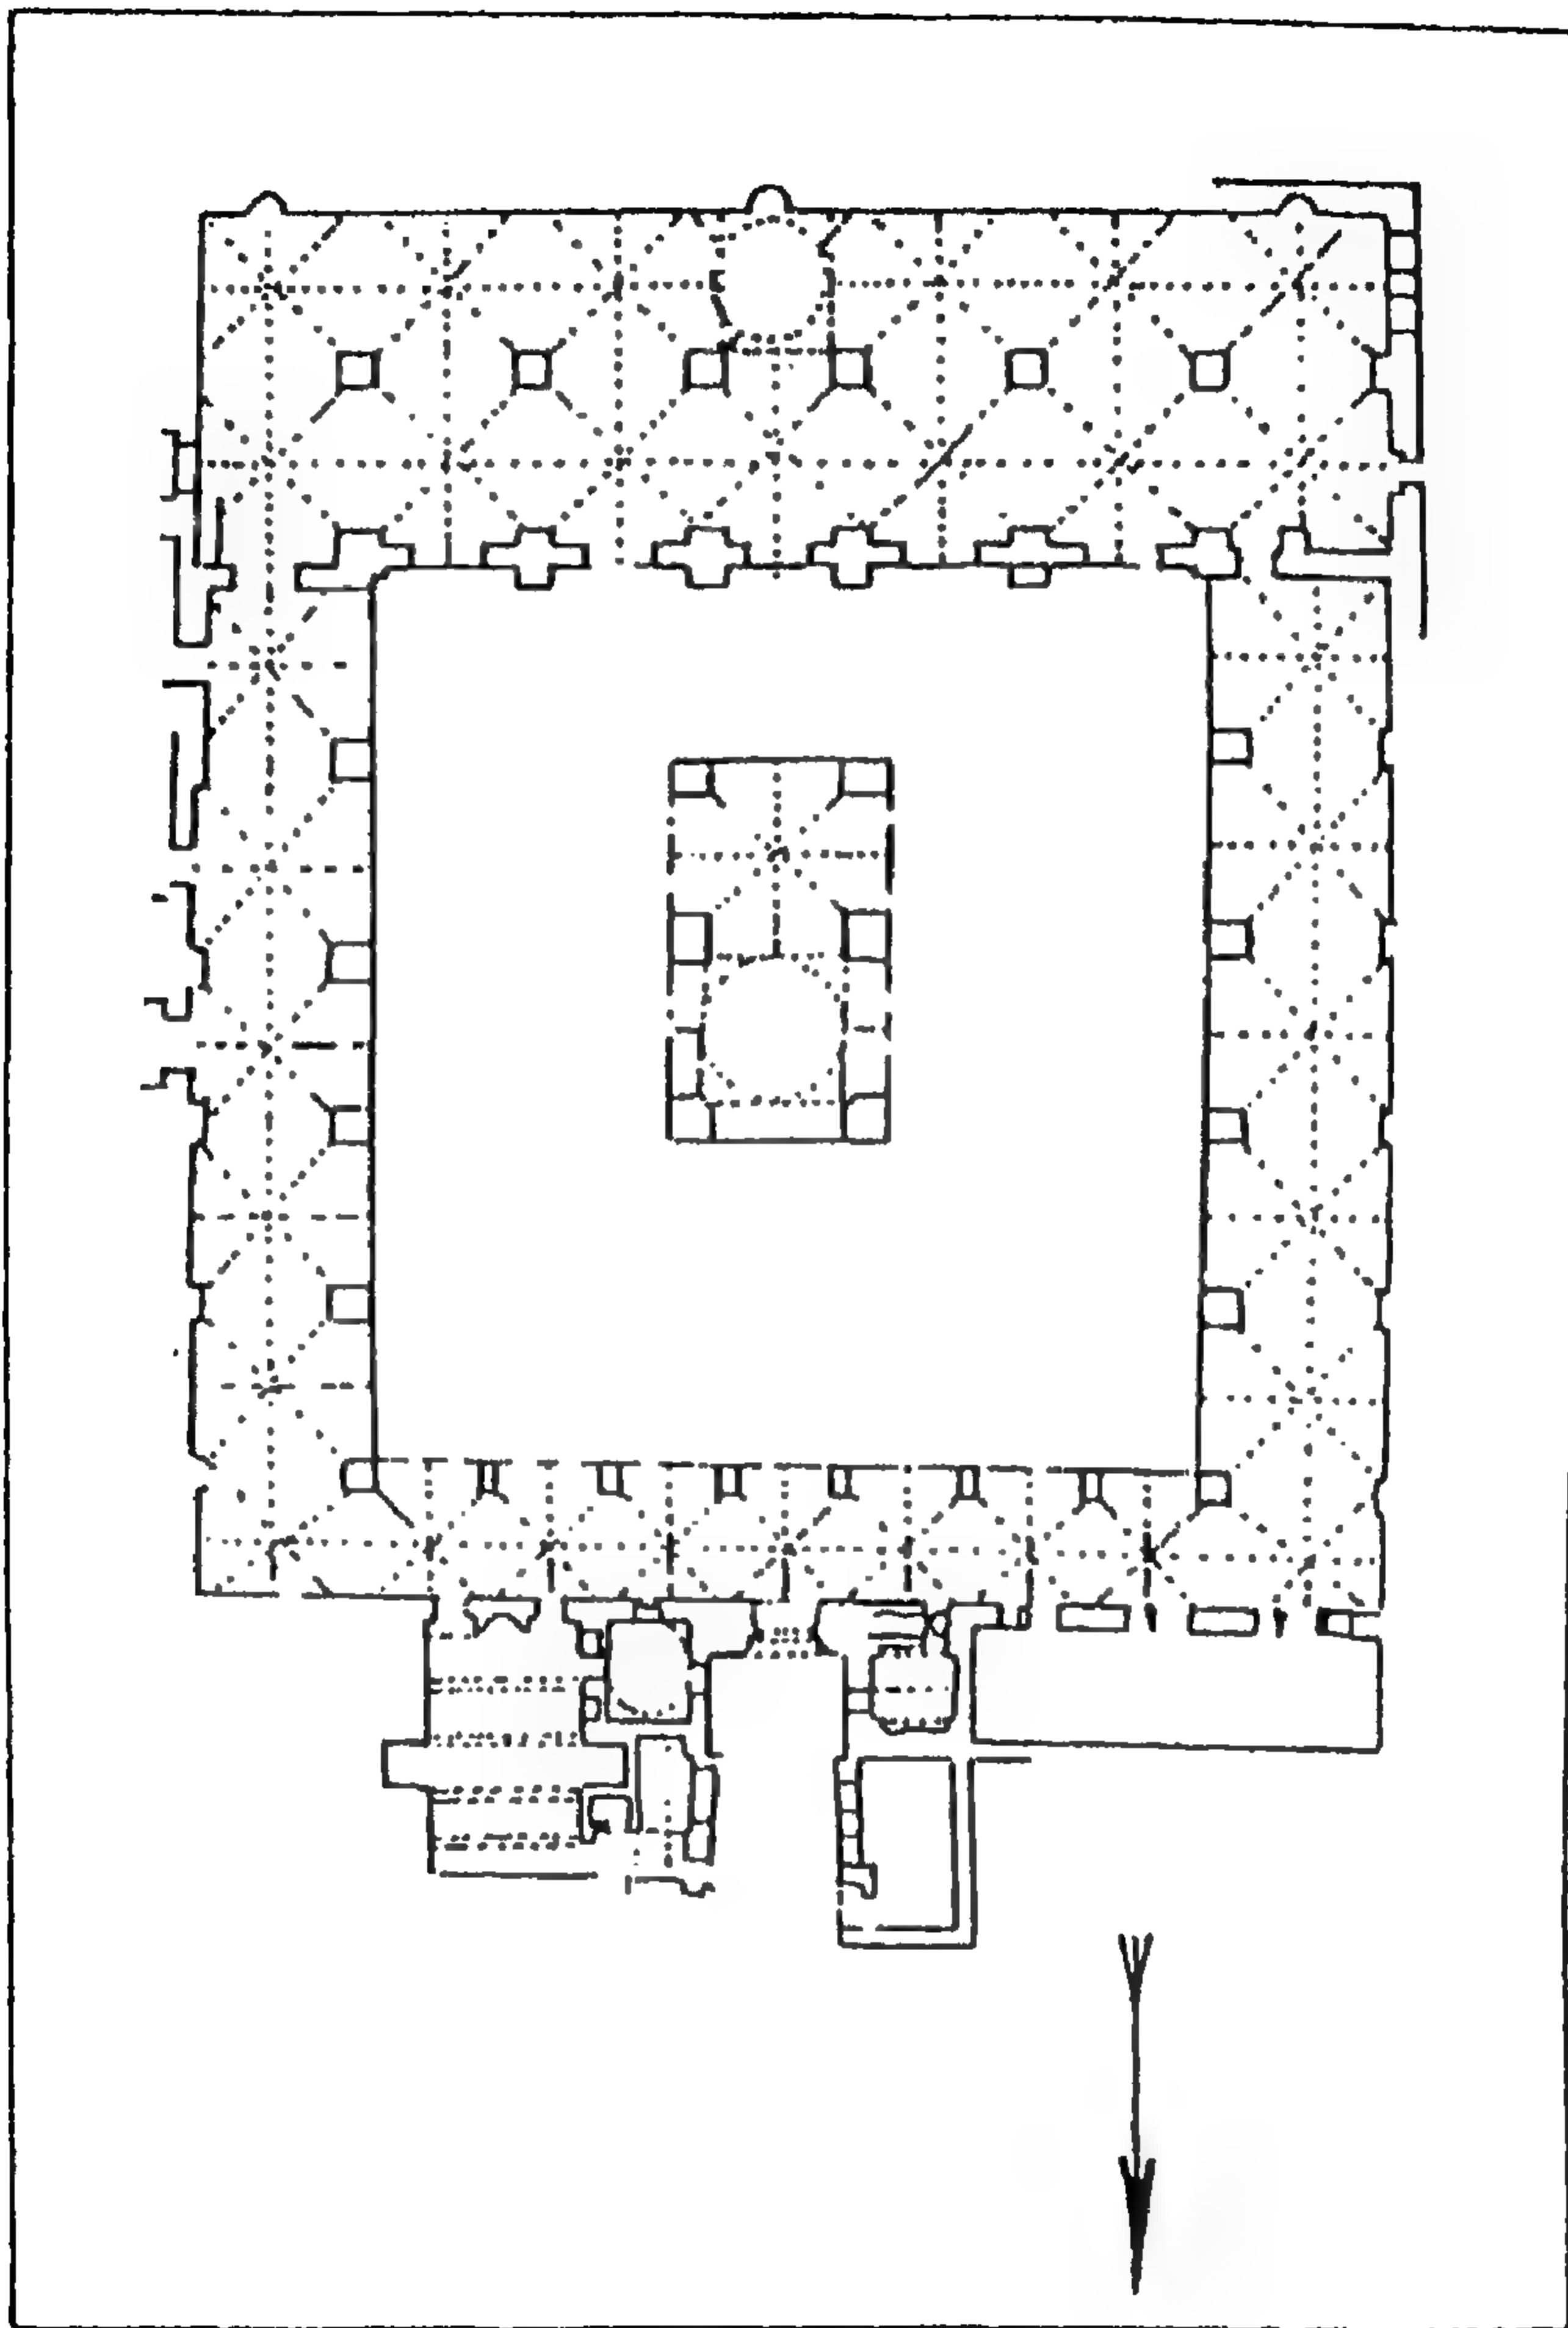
مسقط أفقي لجامع أحمد بن طولون بالقاهرة (عن لجنة حفظ الآثار العربية)
